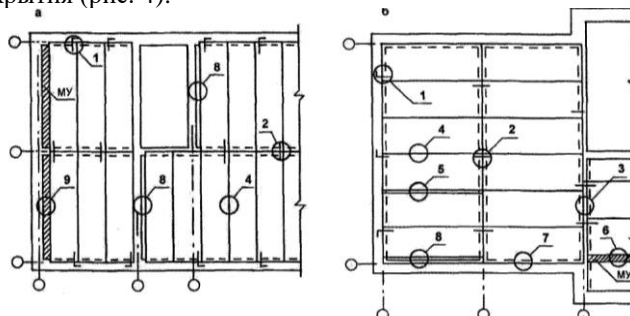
Фрагмент схемы расположения сборных железобетонных элементов перекрытия в зданиях с кирпичными стенами:
